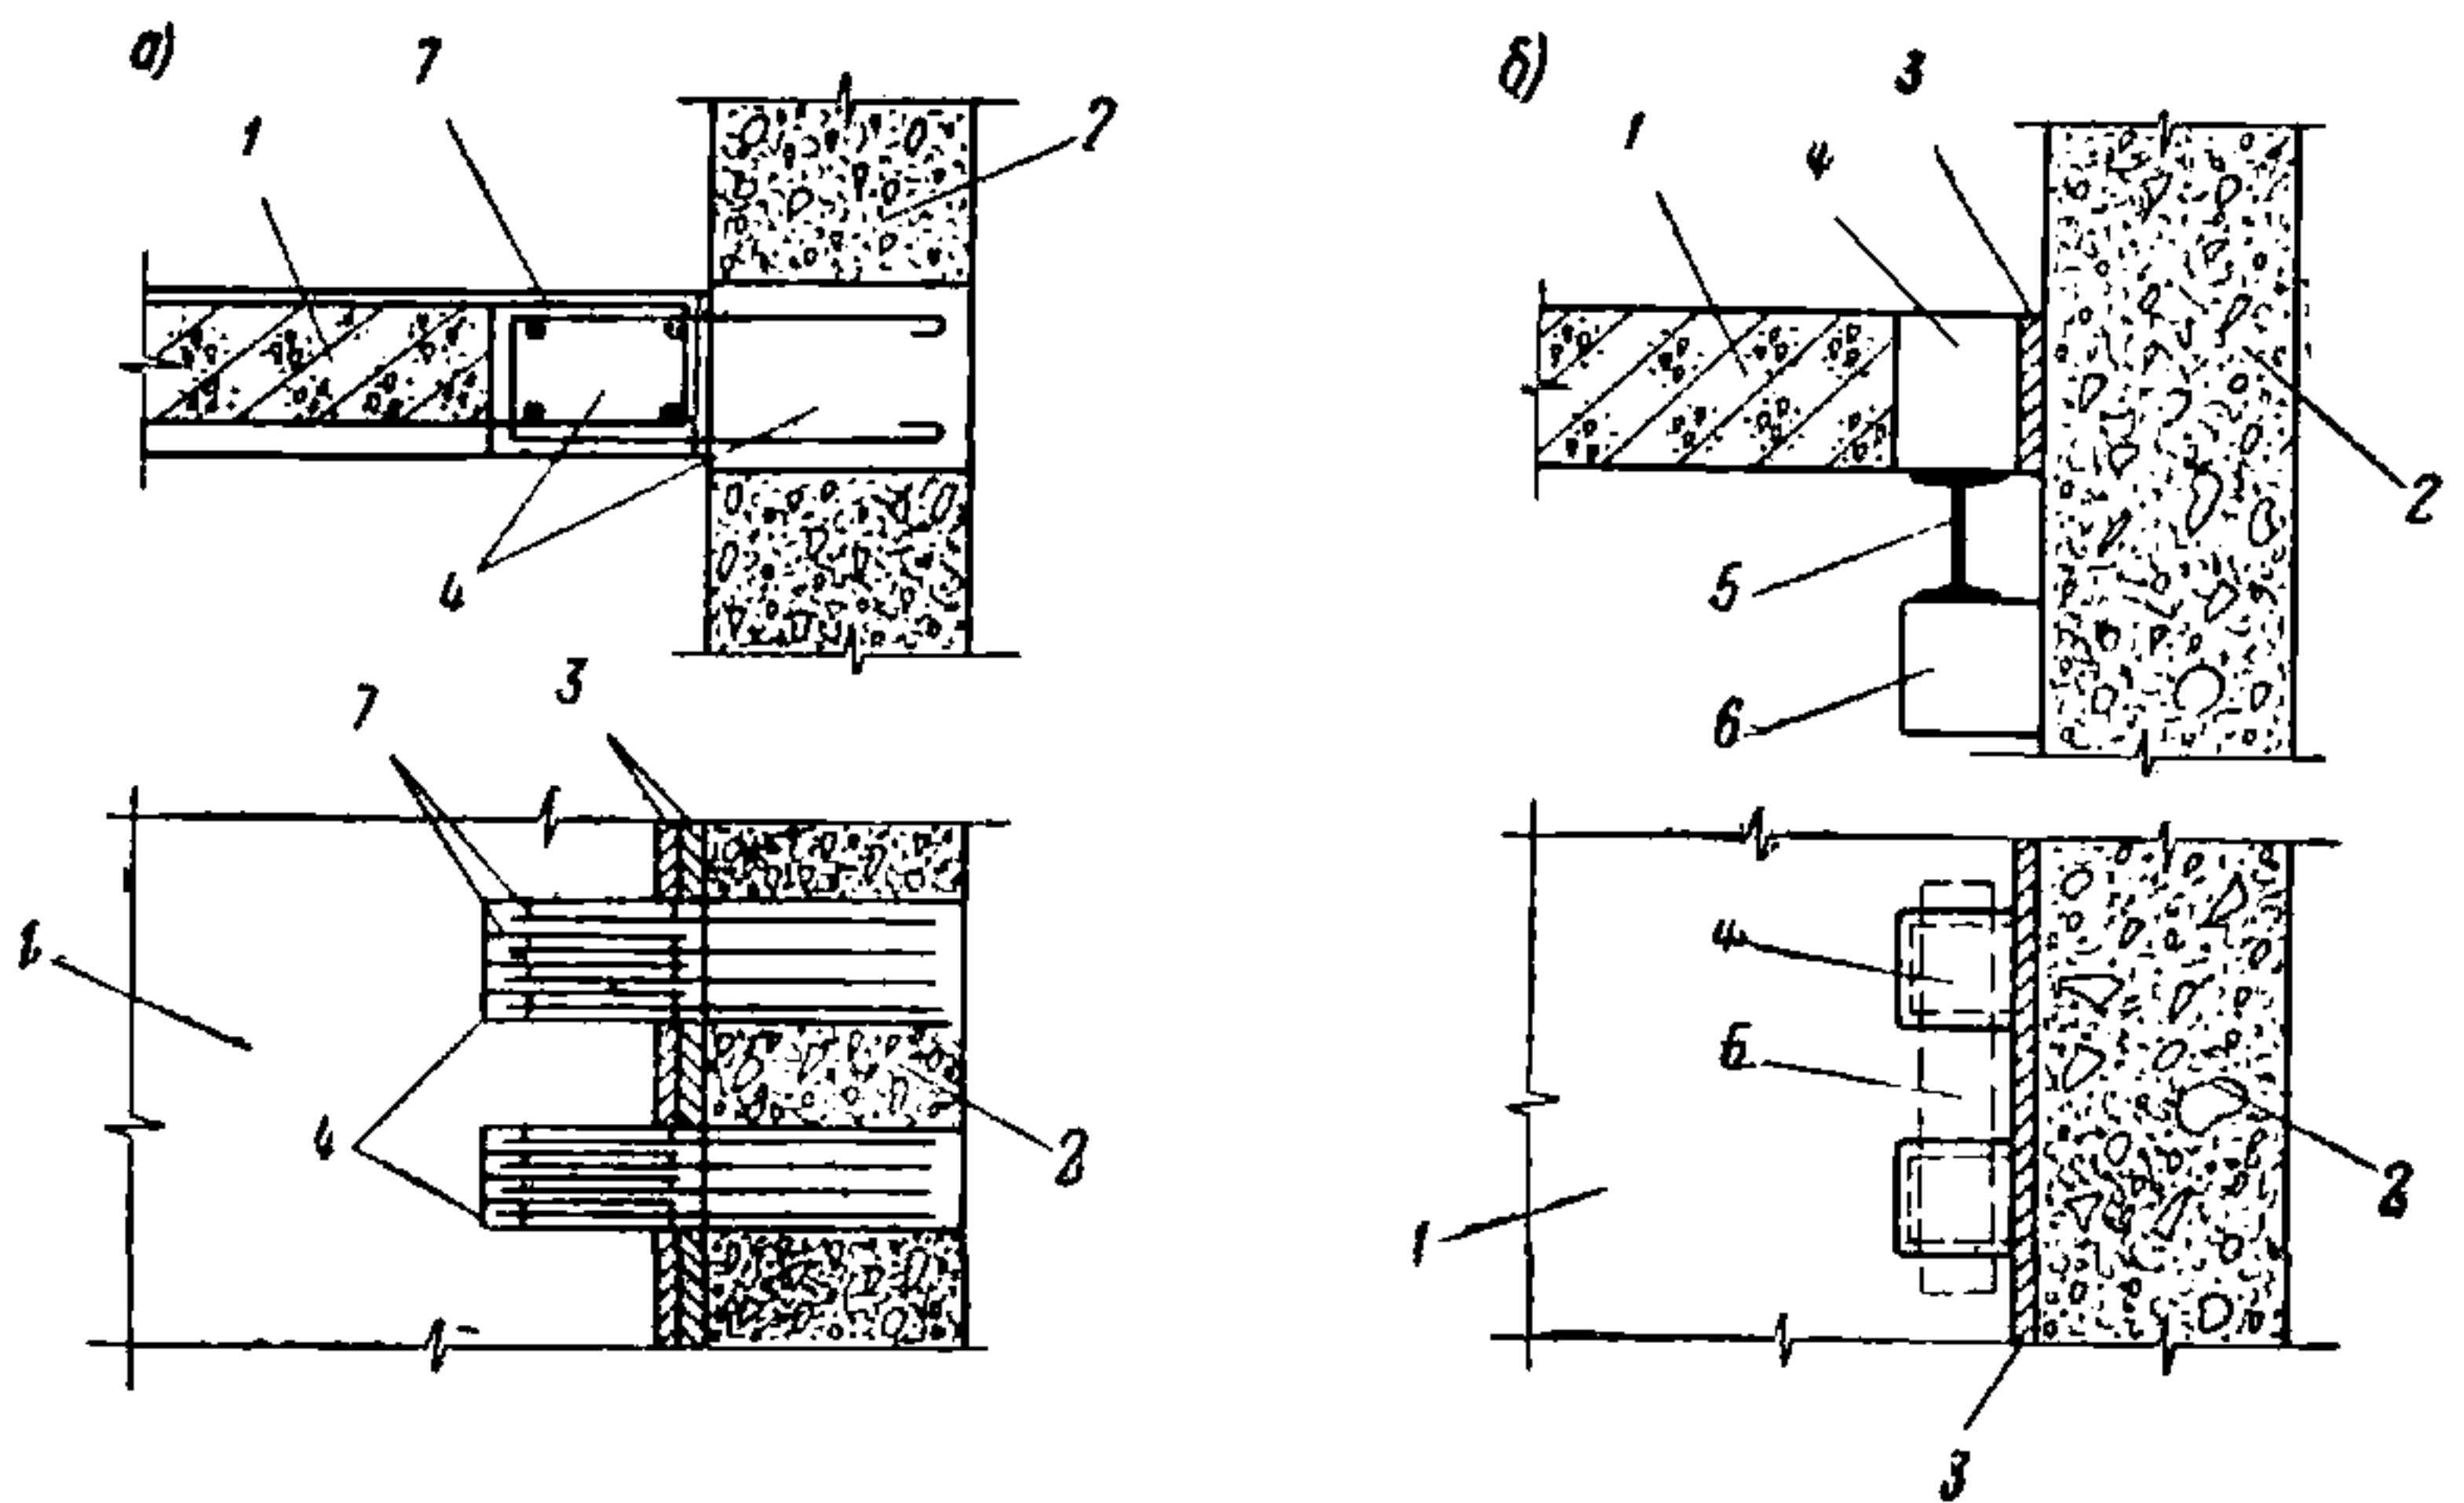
Примеры сопряжения перекрытия с ядром жесткости
